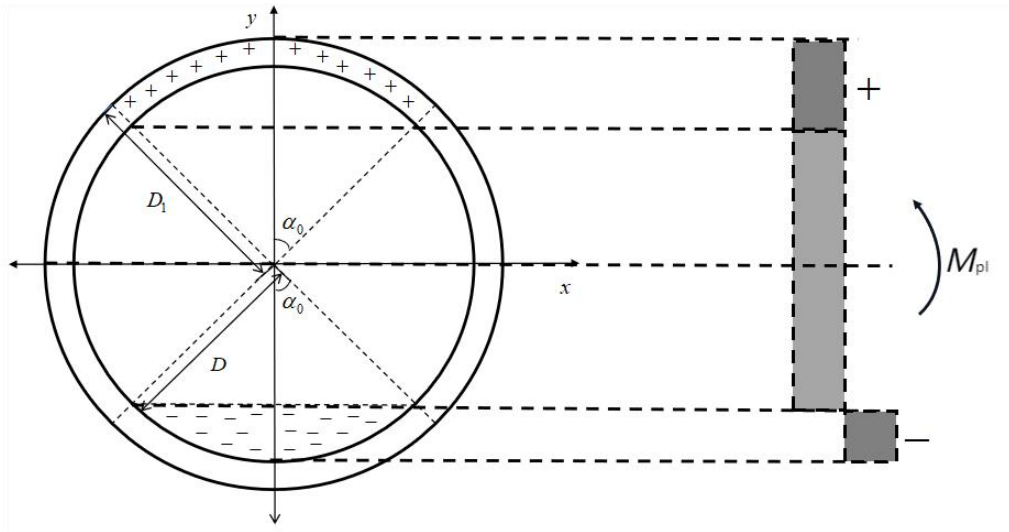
纯弯状态下圆钢管混凝土截面弯矩的计算示意图
